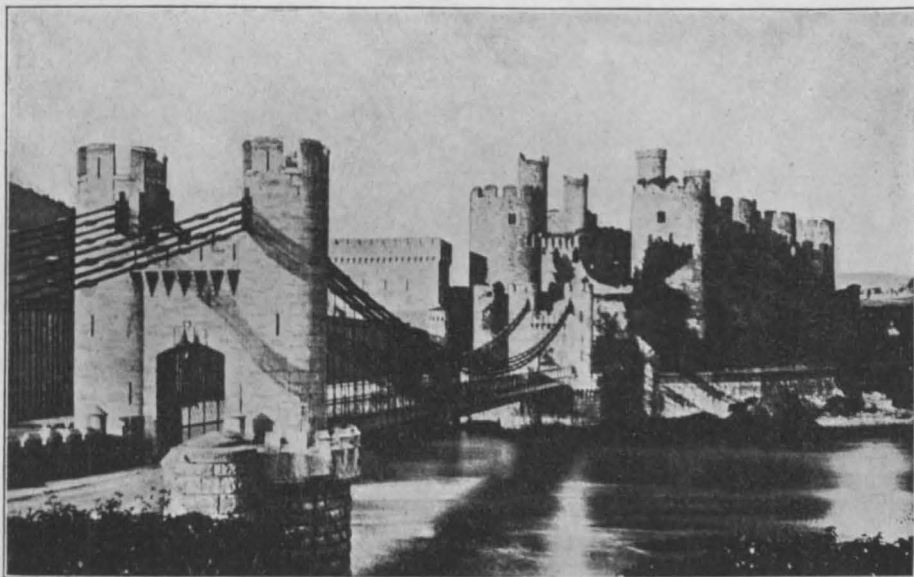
Kettenbrücke bei Schloß Conway in der Straße London-Dublin. 1822—1826.
